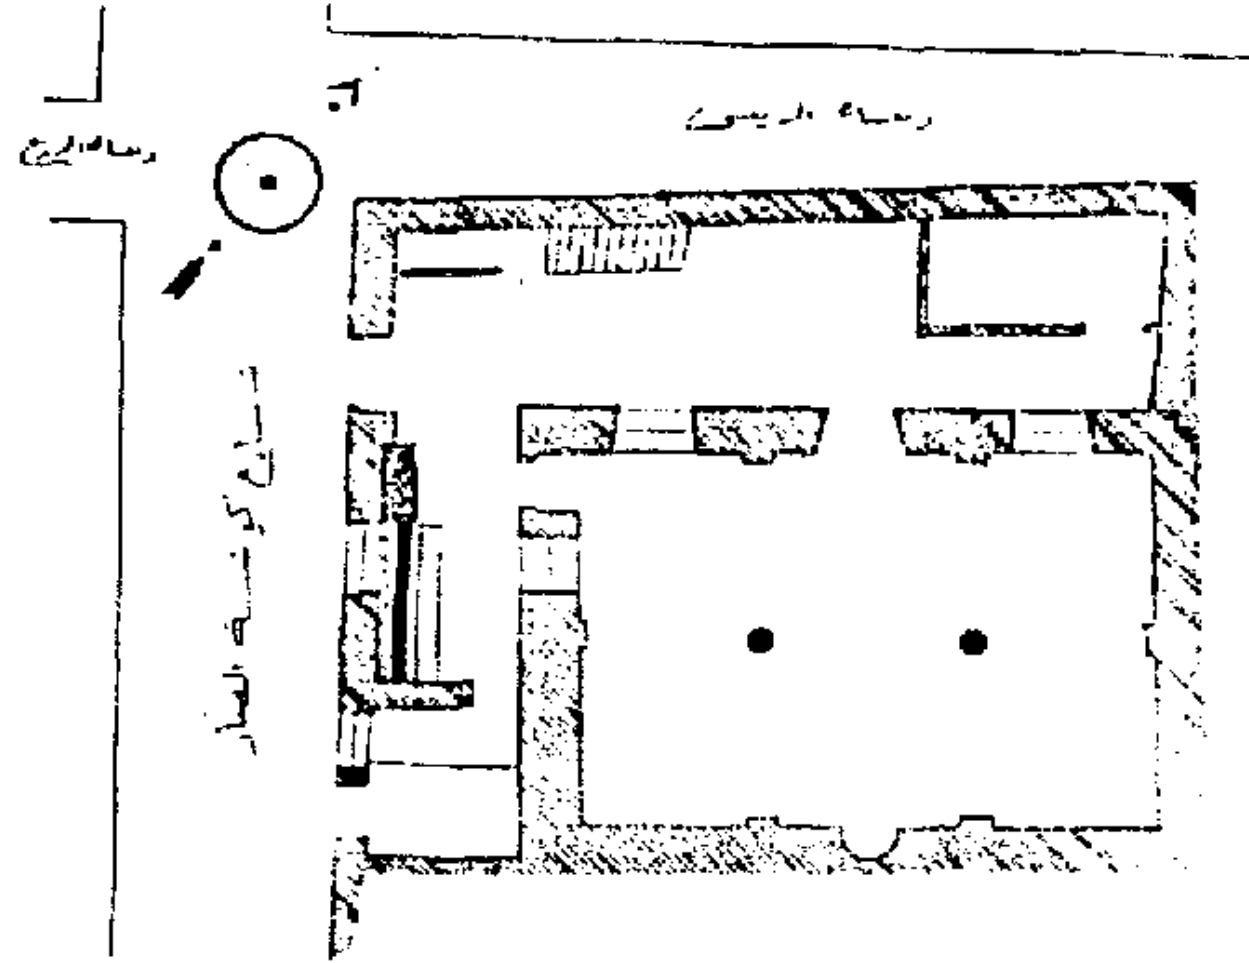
مسقط أفقي لجامع درغوت باشا عن الموسوعة (الجزء الأول).
